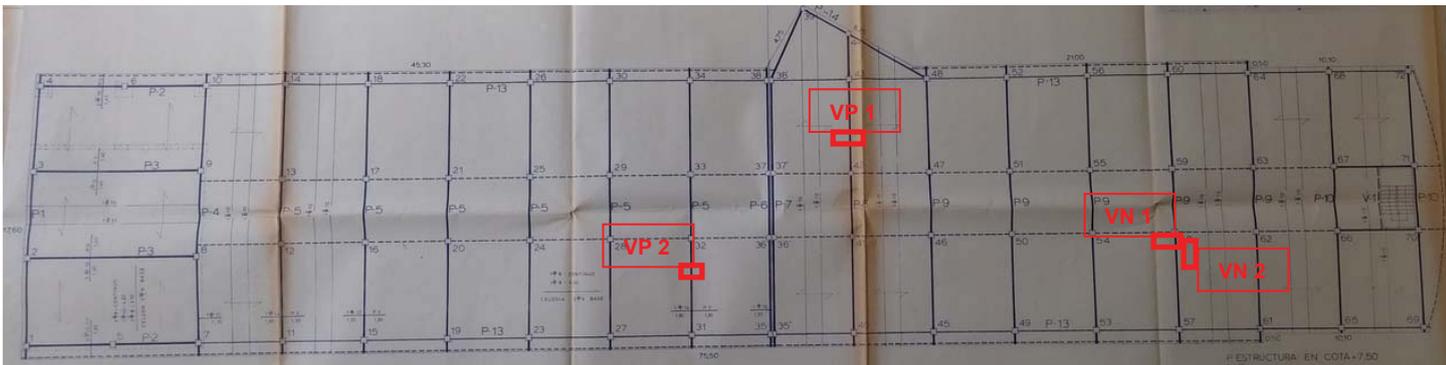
Plano de forjado de proyecto sobre el que se ubican las catas y rozas realizadas en vigas.
